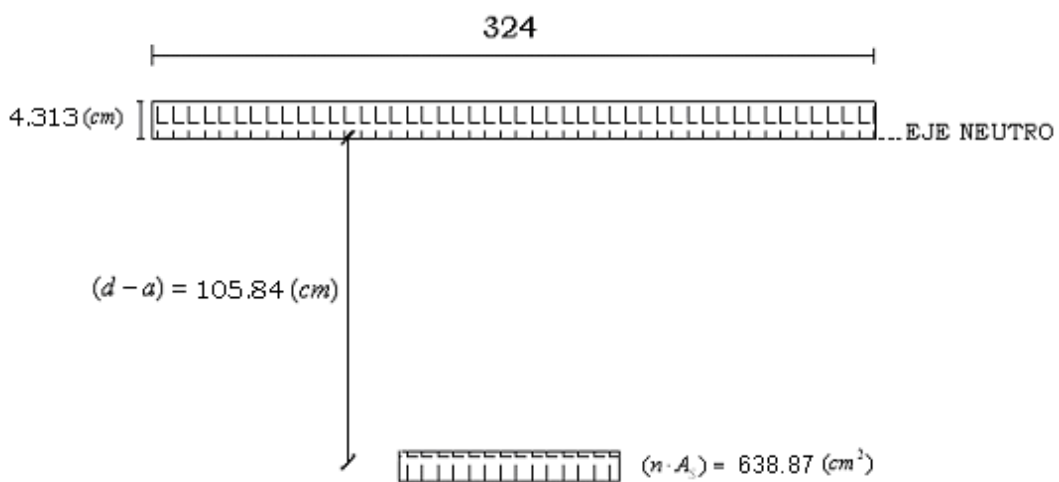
Sección fisurada de la viga. Dimensiones en (cm)
